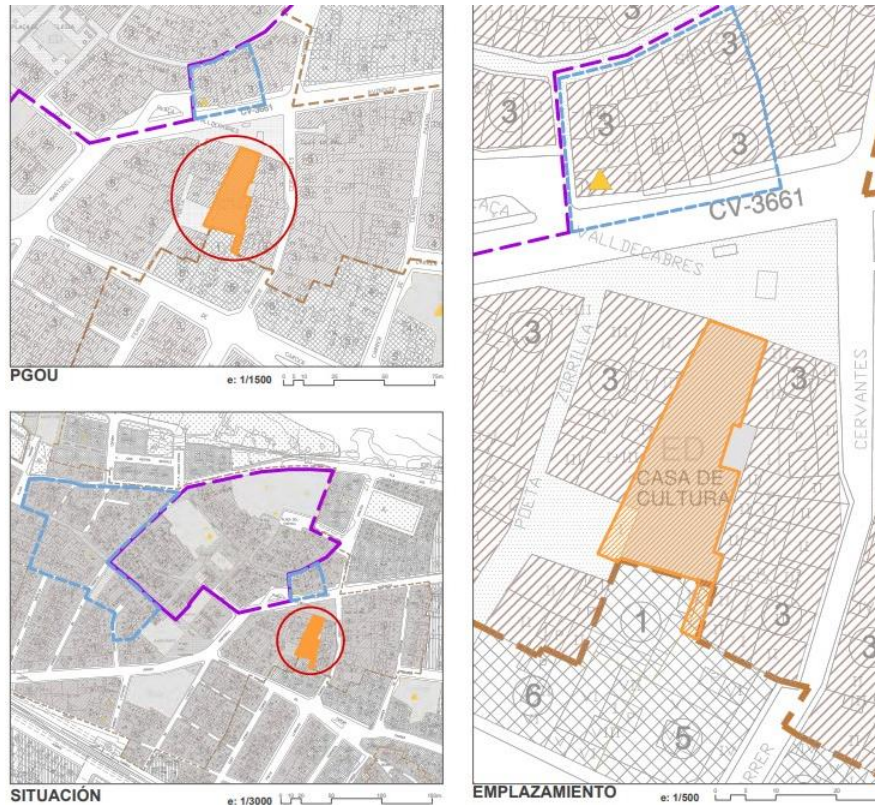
Plano de situación. Fuente: Planos del proyecto.
